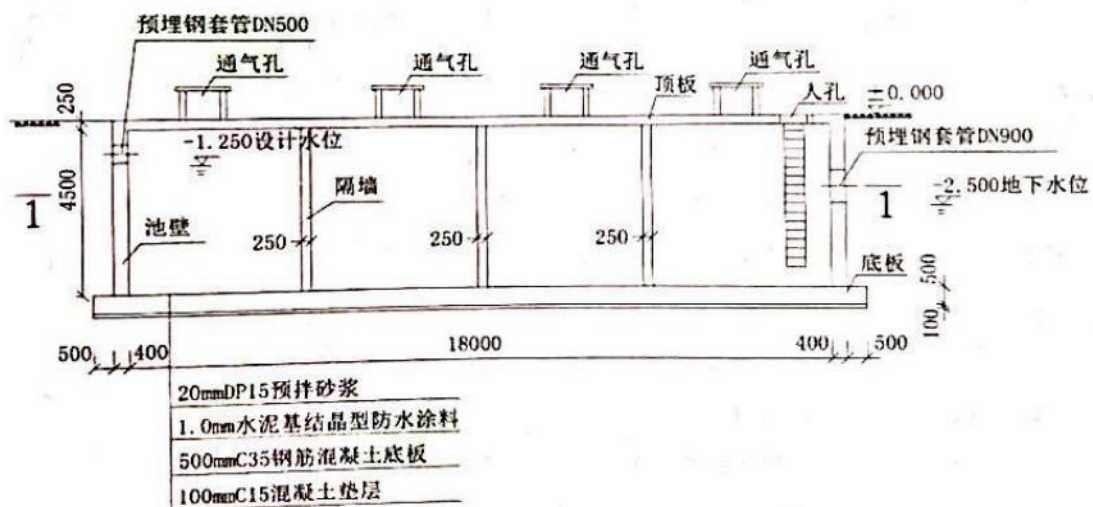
水池剖面图 (标高单位: m; 尺寸单位: mm)
